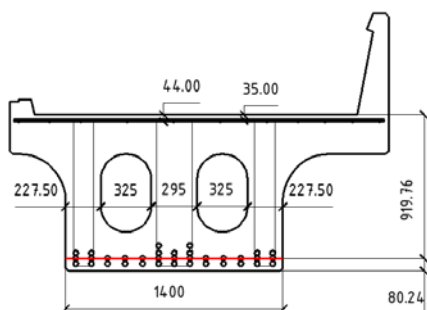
Плитна прогонова будова з поздовжніми овальними отворами. Розташування арматури. Варіант № 3
